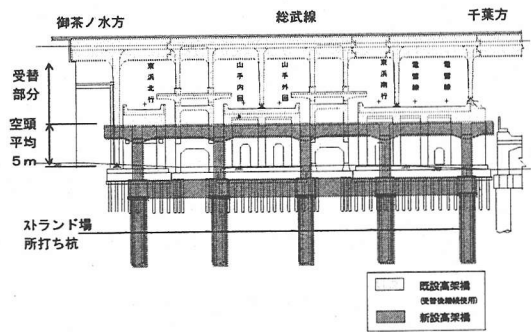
秋葉原駅改修断面図(図-7 ; A-A断面)
